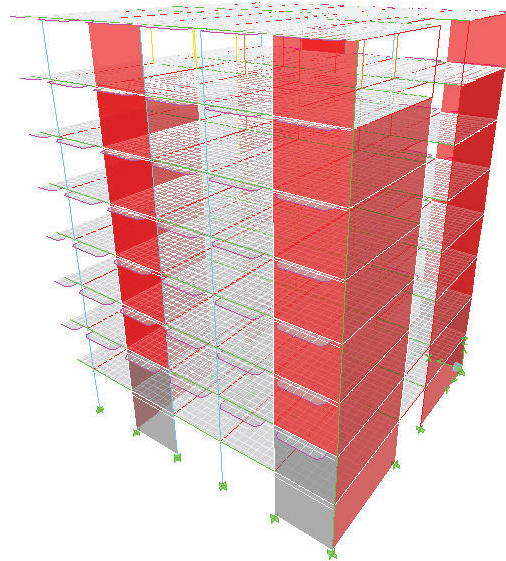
VISTA SUR MODELO ETABS CON PAREDES ENCHAPADAS BLOQUE B
